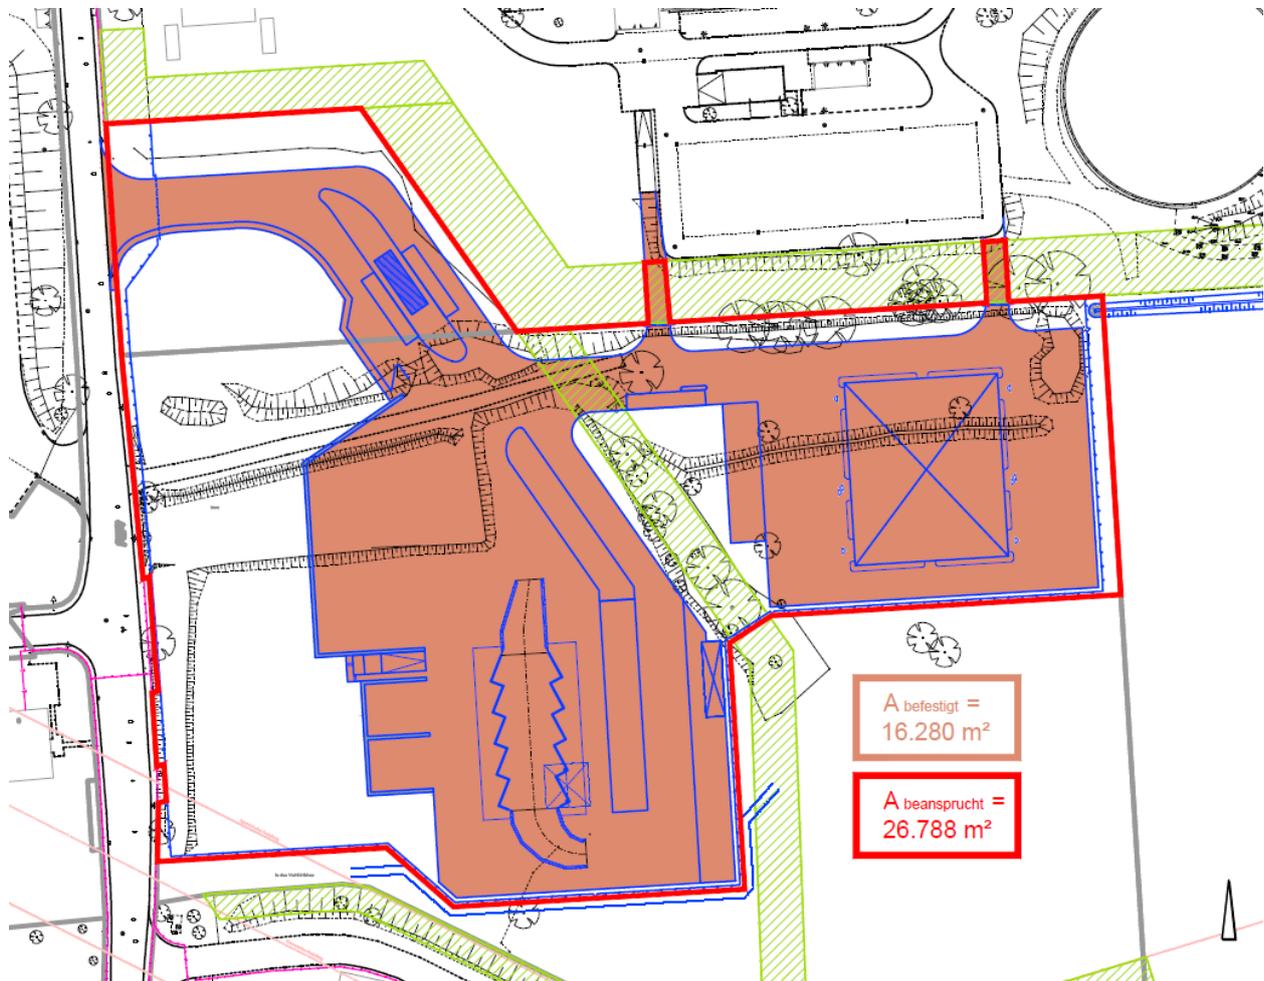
Lageplanausschnitt mit Flächenzuordnung
